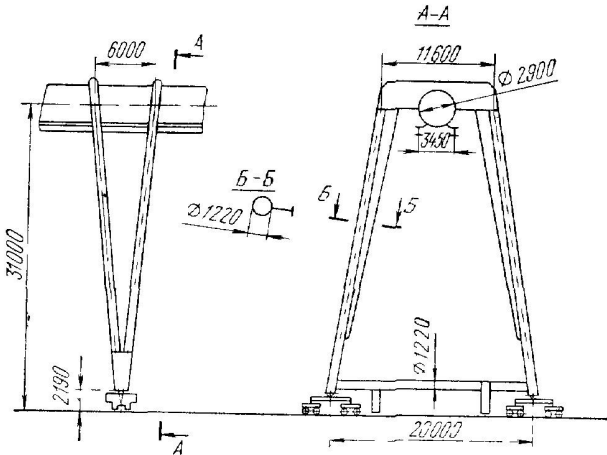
Опора перевантажувача трубчасто-балочної конструкції.
